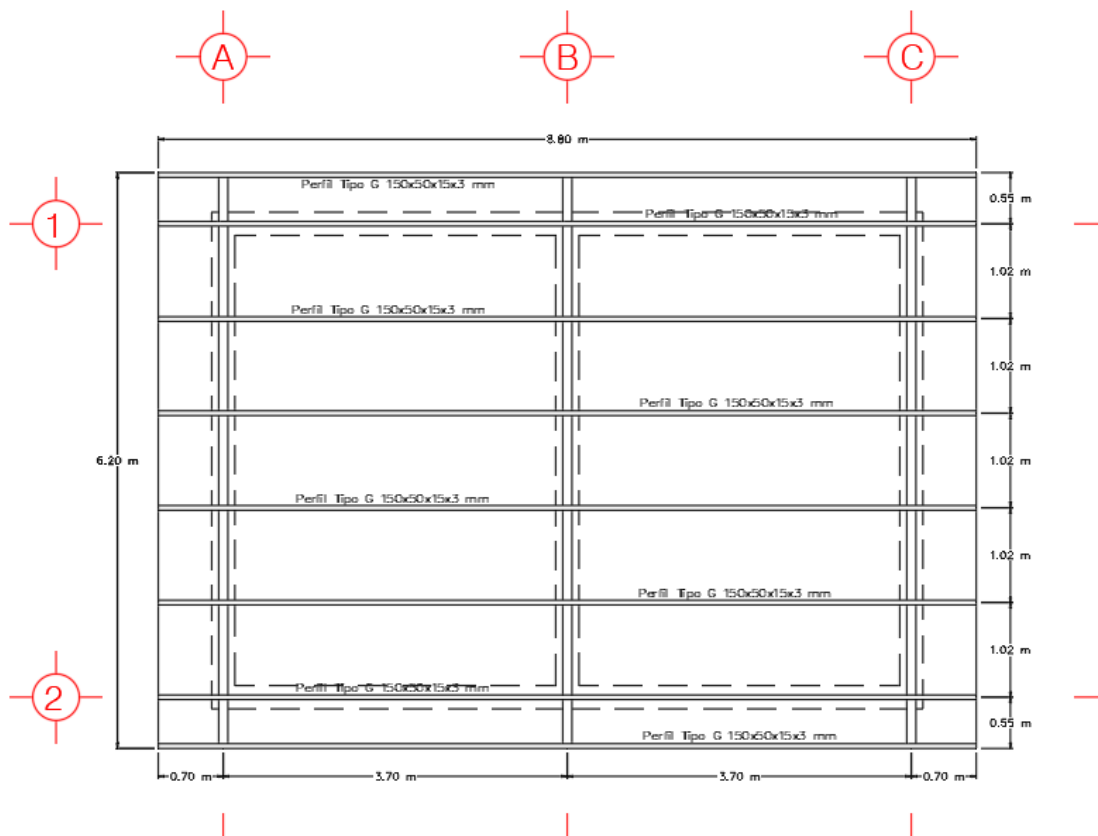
Planta de la cubierta propuesta sobre el lecho de secado de lodos.
